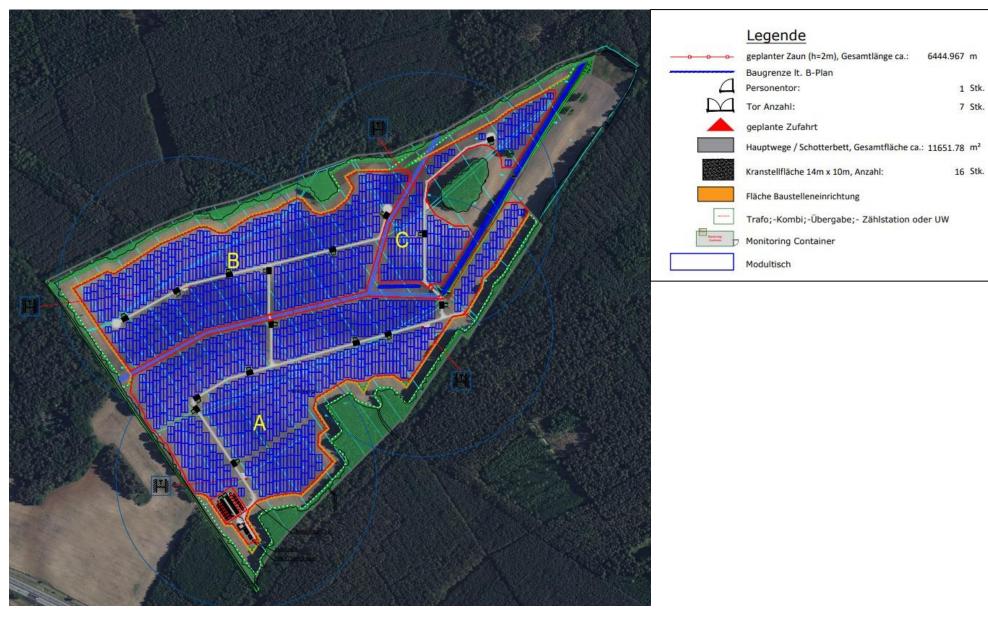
Entwurfsplan: Modullayout des B-Plans Nr. 2 "Sondergebiet Photovoltaik I" der Gemeinde Stolpe (ENERPARC 2024)
